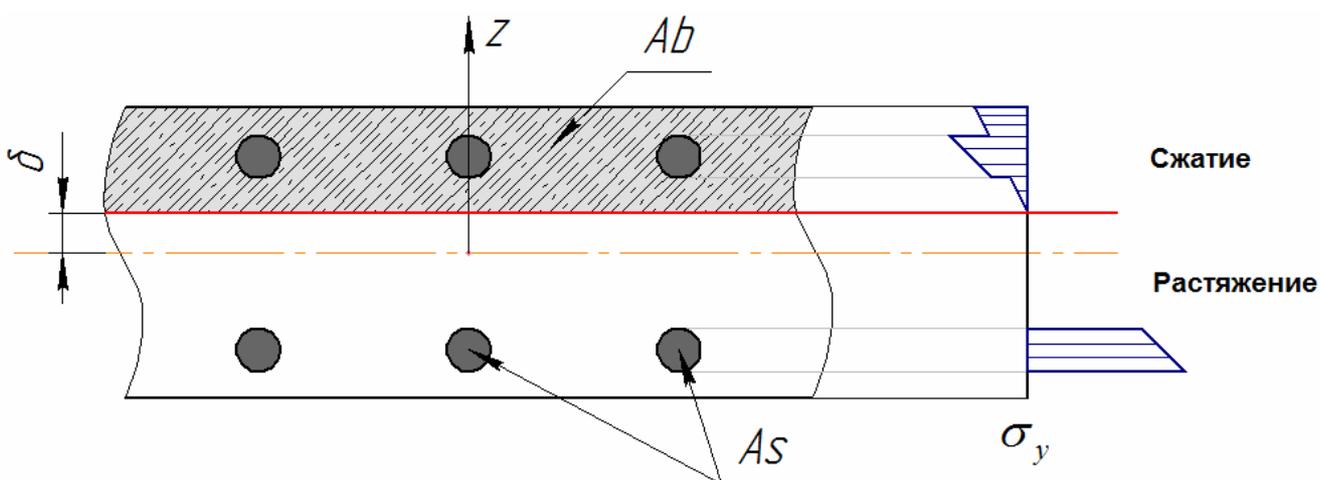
Поперечное сечение ограждения (As – армирующий элемент, Ab – бетон).
